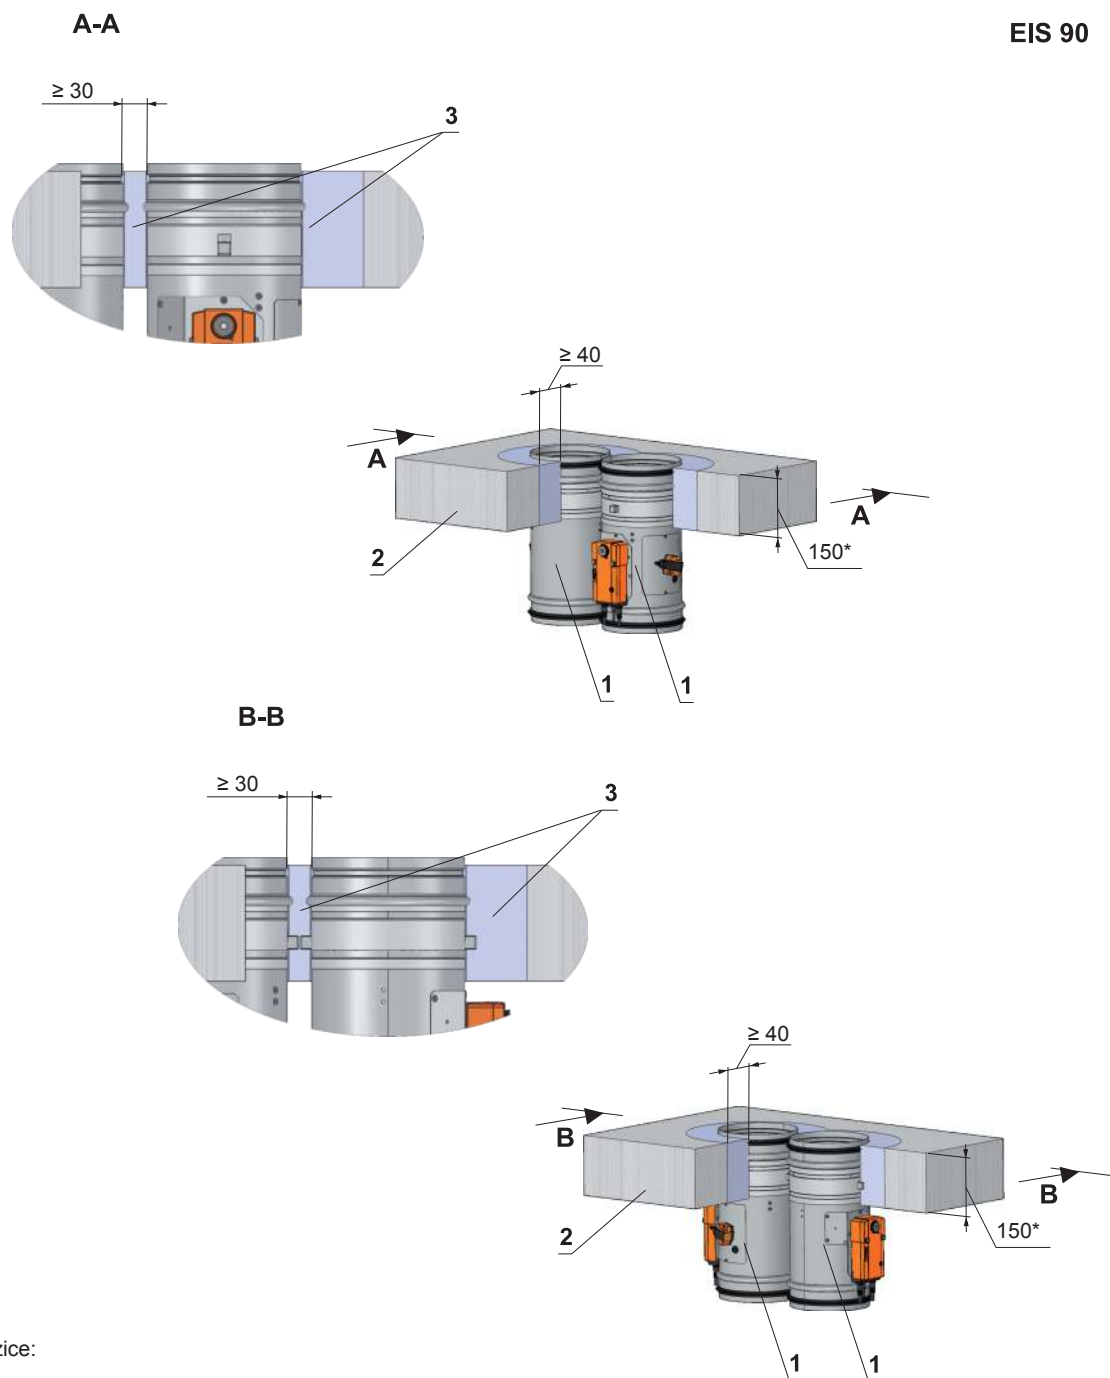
Tuhá stropní konstrukce - sádra nebo malta
